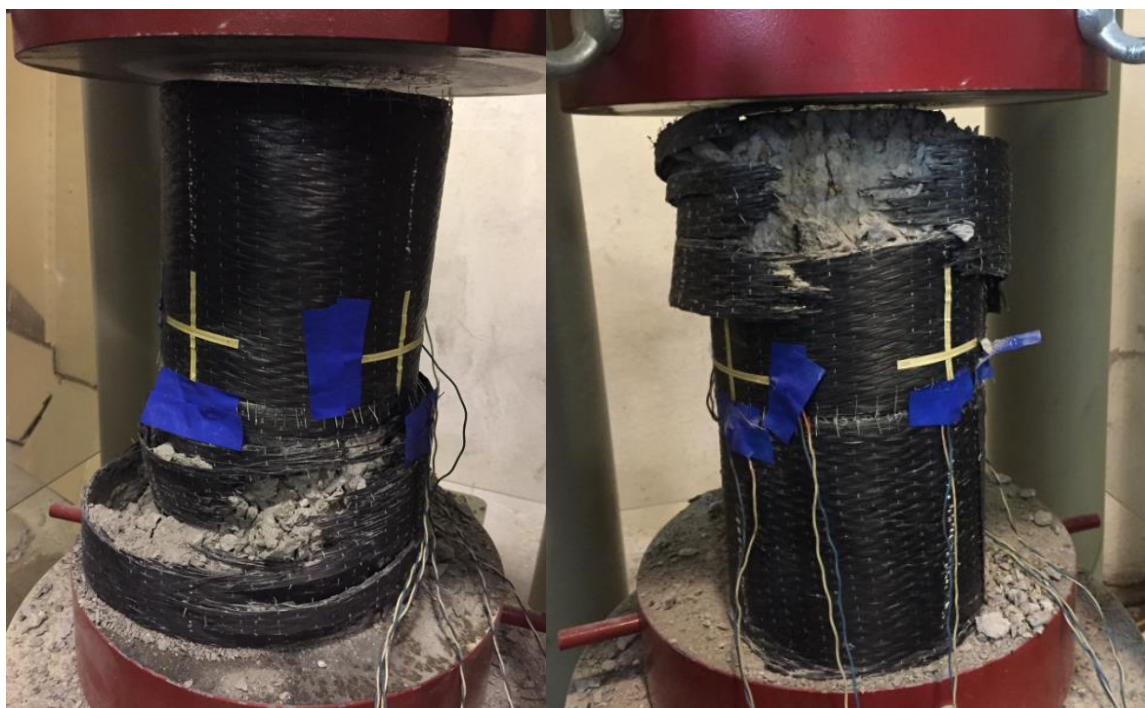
Общий вид разрушения образцов серий K15-2 и K15-3
